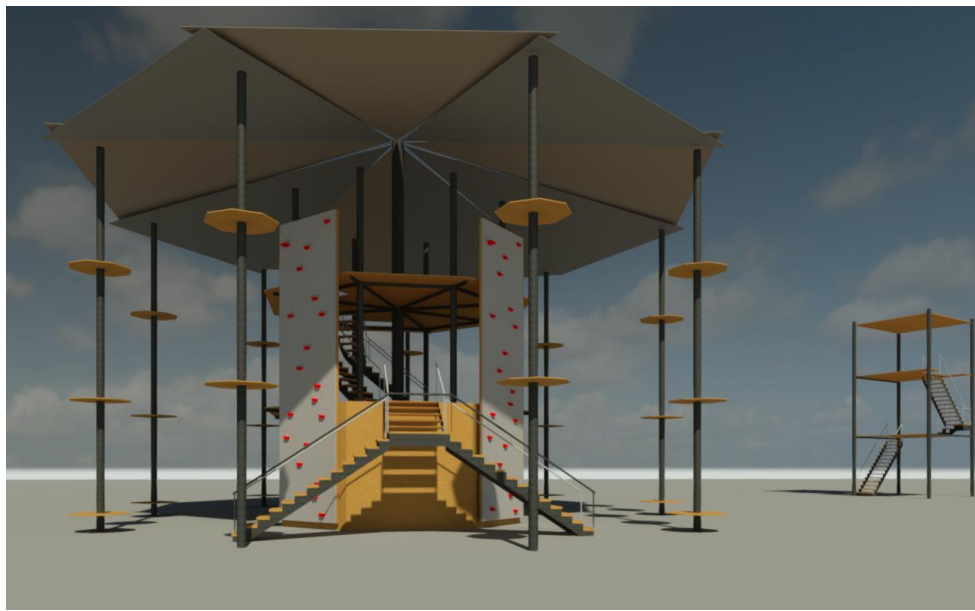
Vista 3D de la torre y la estructura de recepción. Fuente: Memoria de cálculo de la Torre Multiaventura
